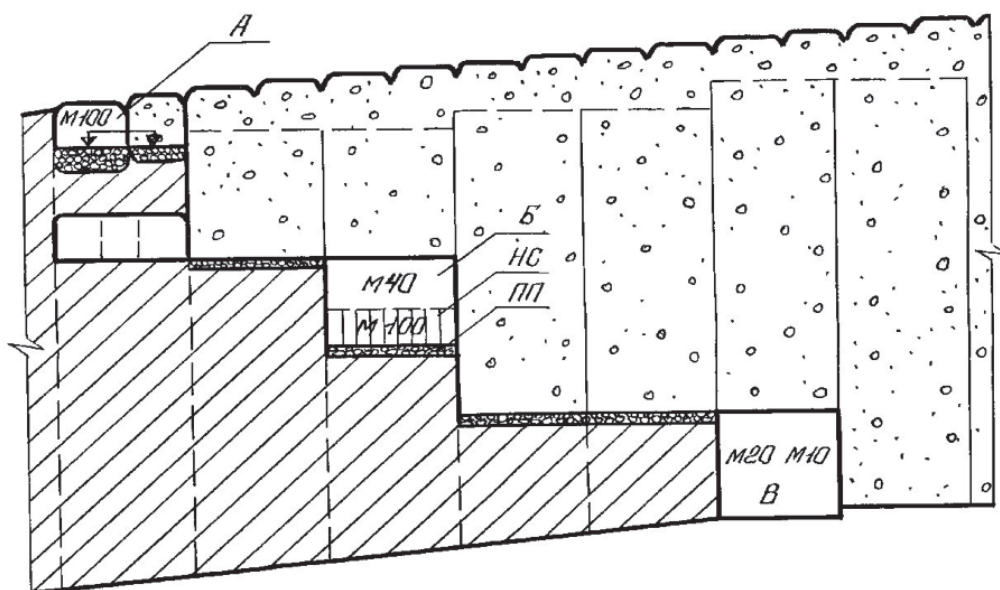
Формирование закладочного массива при нисходящем порядке выемки: А – секционное возведение искусственной кровли в выработках защитного перекрытия; Б – закладка основных слоев; В – погашение пустот последнего слоя в ленте; НС – несущий слой; ПП – предохранительная подсыпка
